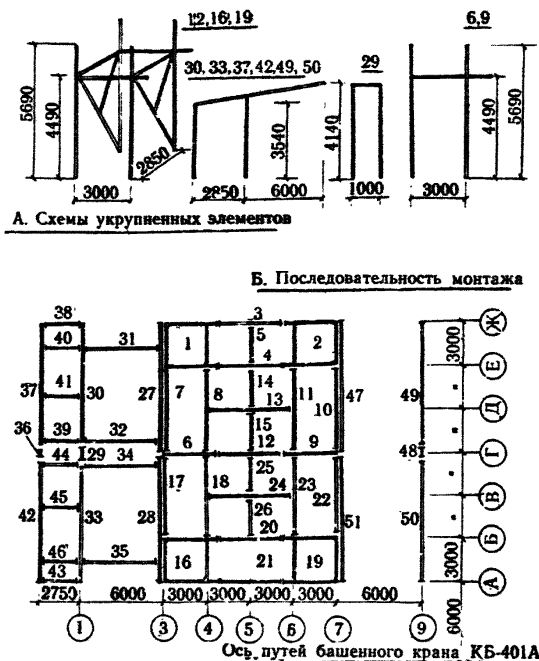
Технологическая схема монтажа I яруса металлических конструкций надстройки рабочего здания РС 4х175 одним башенным краном
